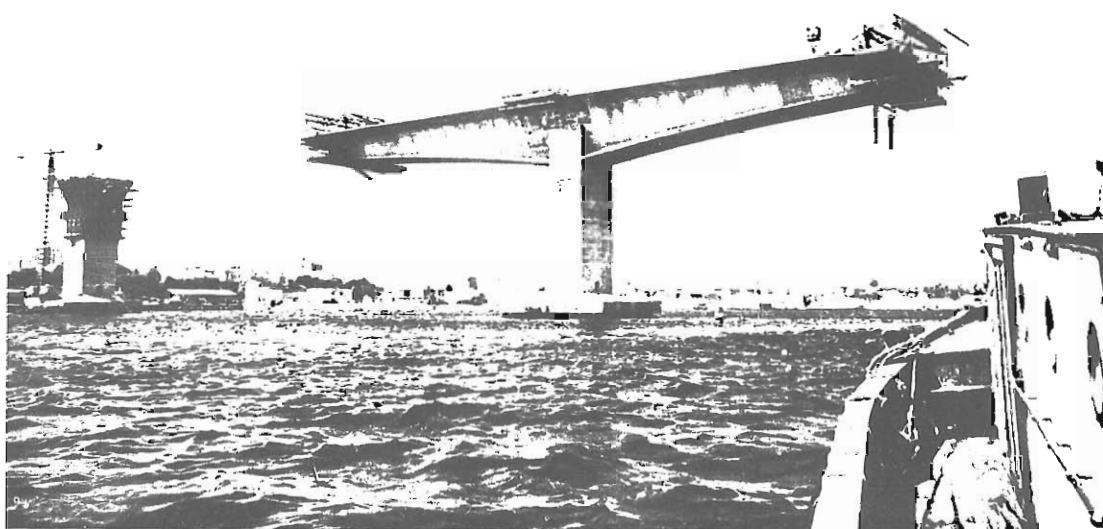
Puente sobre el Mar Piccolo en Tarento. Vista durante construcción.
